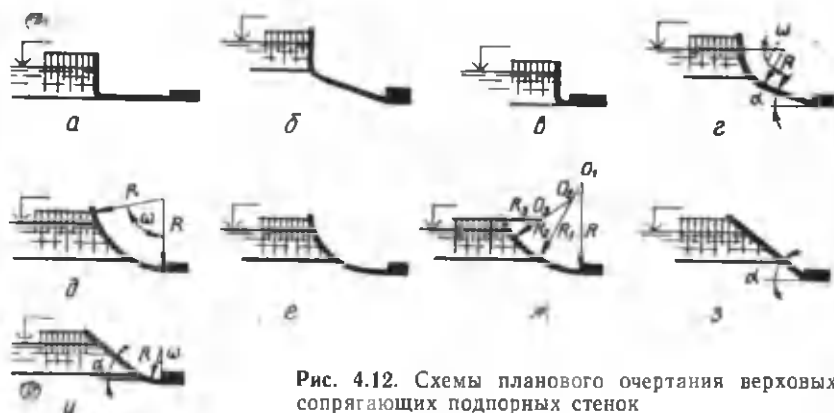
Схемы планового очертания верховых сопрягающих подпорных стен
